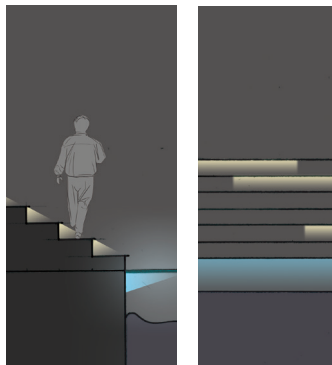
Schnitt und Ansicht - Beleuchtung Wasserkante
